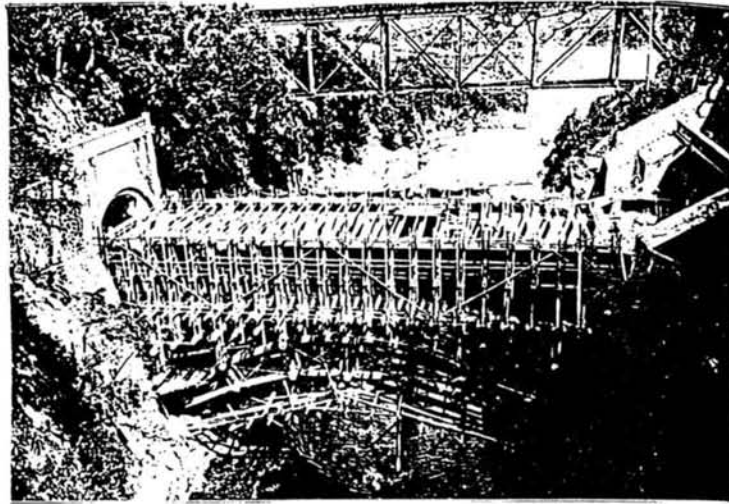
猿橋水道橋、水路樋部の施工中<sup>68)</sup>
